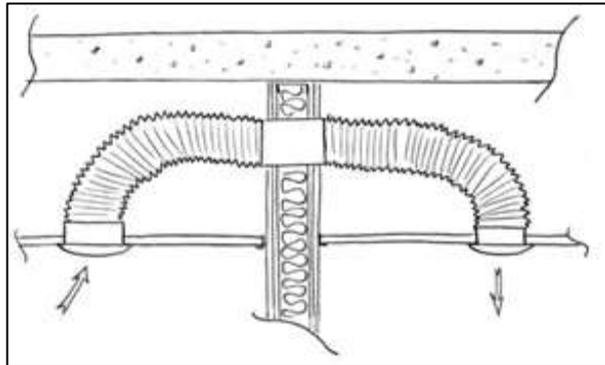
Schéma de principe de la mise en œuvre d'un transfert d'air à travers un plafond.
